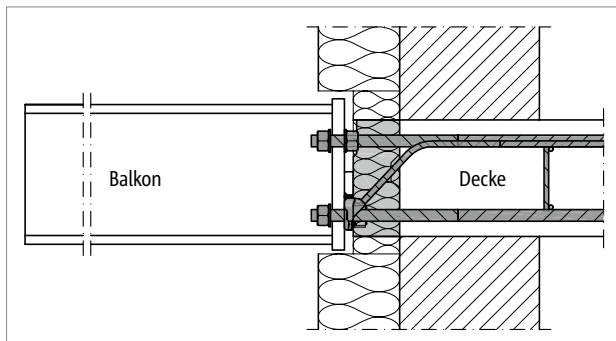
Schöck Isokorb® T Typ SKP: Anschluss an die Stahlbetondecke; Dämmkörper innerhalb der Aussendämmung
